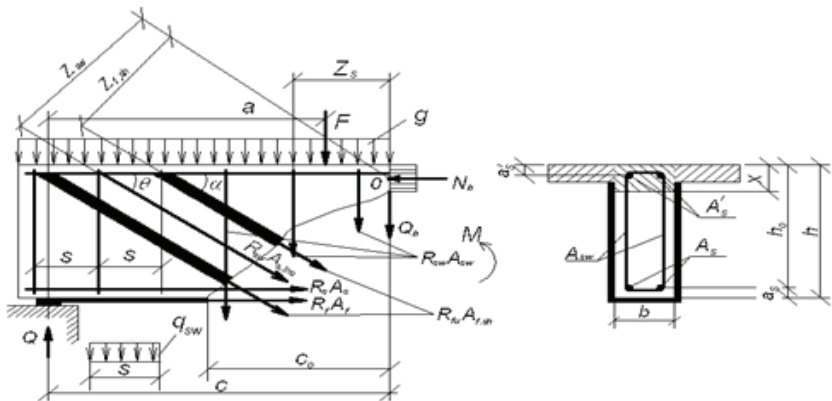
Расчетная схема наклонного сечения на поперечную силу и изгибающий момент
